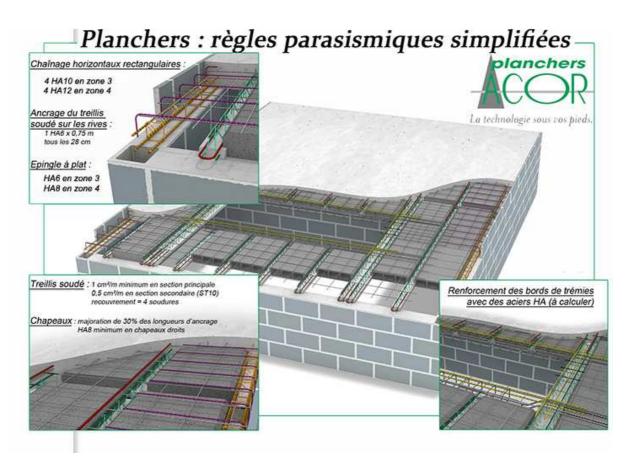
règles PS-MI 89 rév. 92 applicables aux planchers
